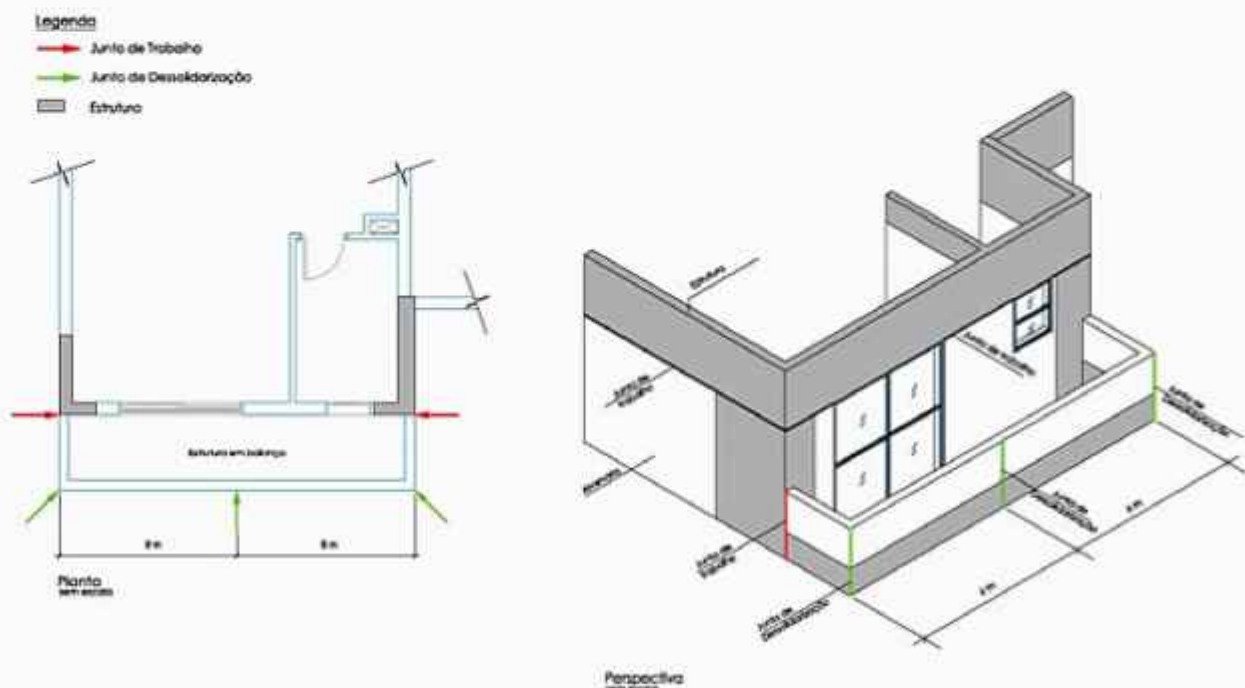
Exemplo de posicionamento de juntas de movimentação em projeto – planta e perspectiva.
